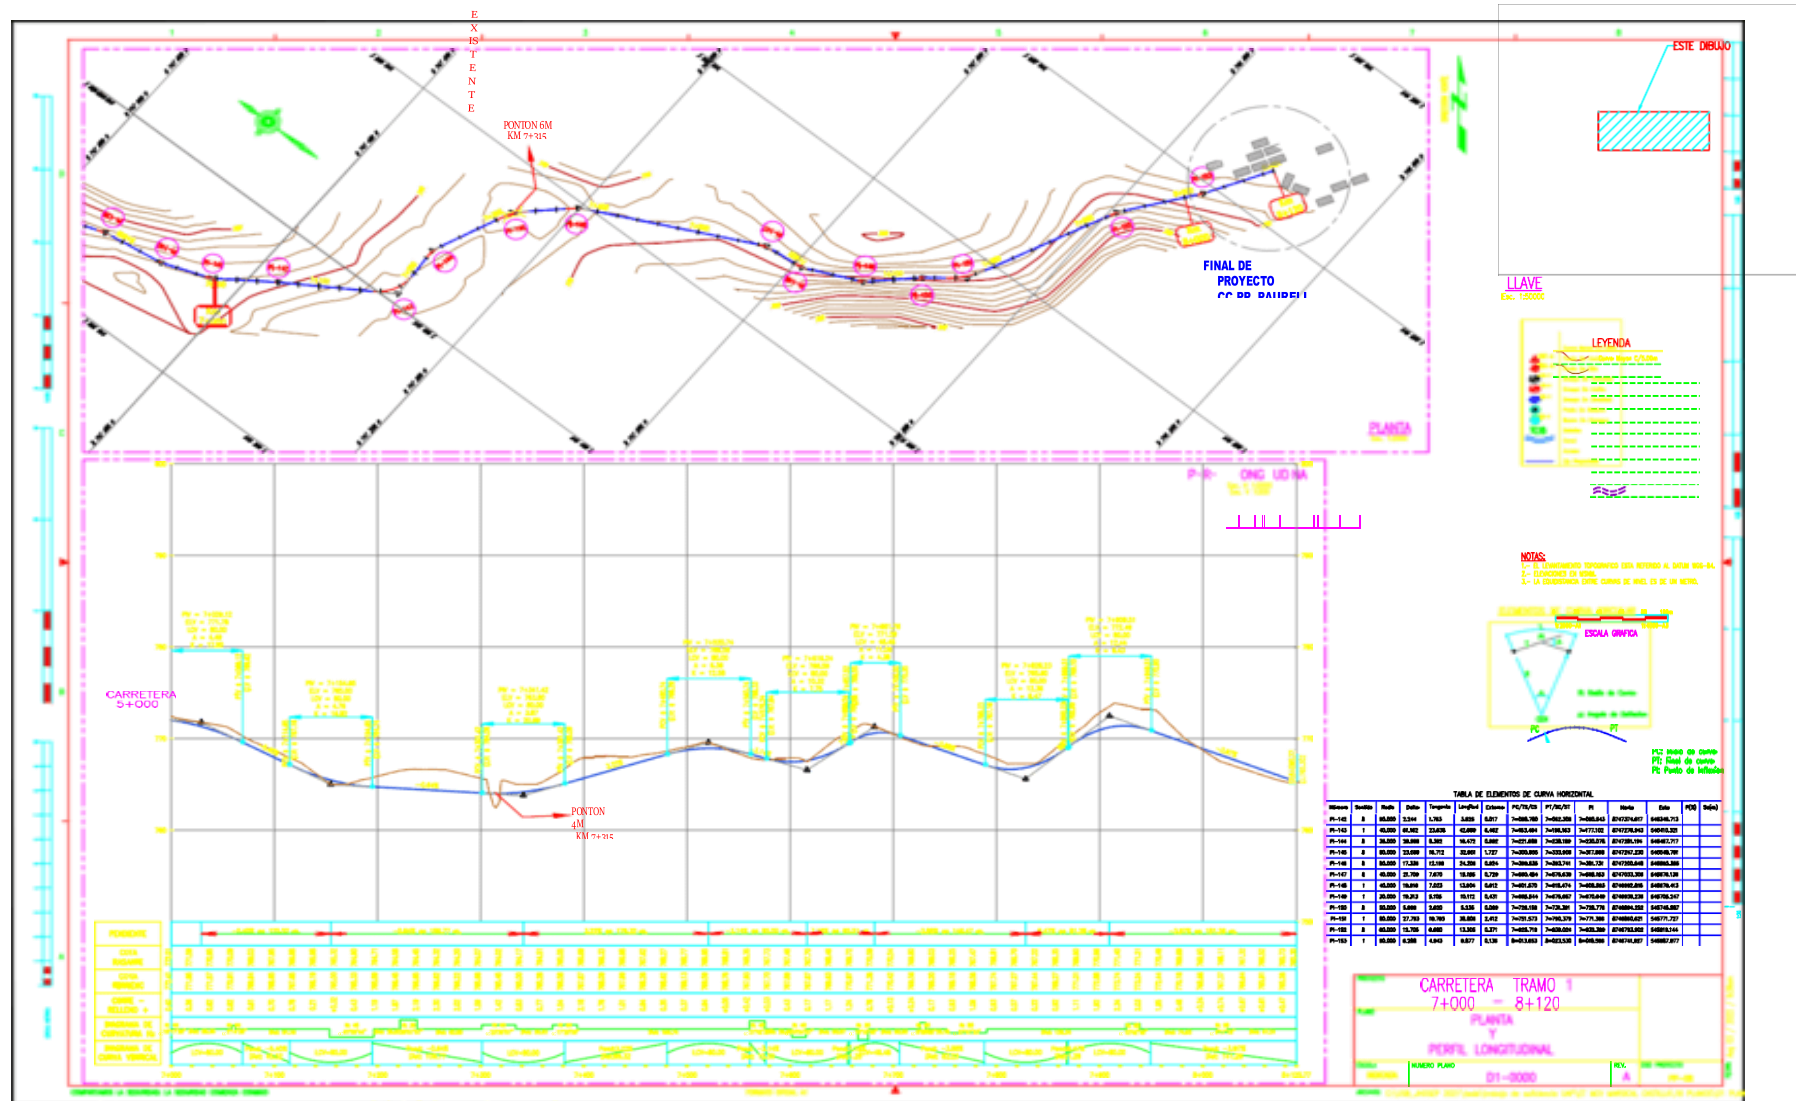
Carretera en planta y perfil longitudinal, tramo 1 (0+000 – 8+120)
